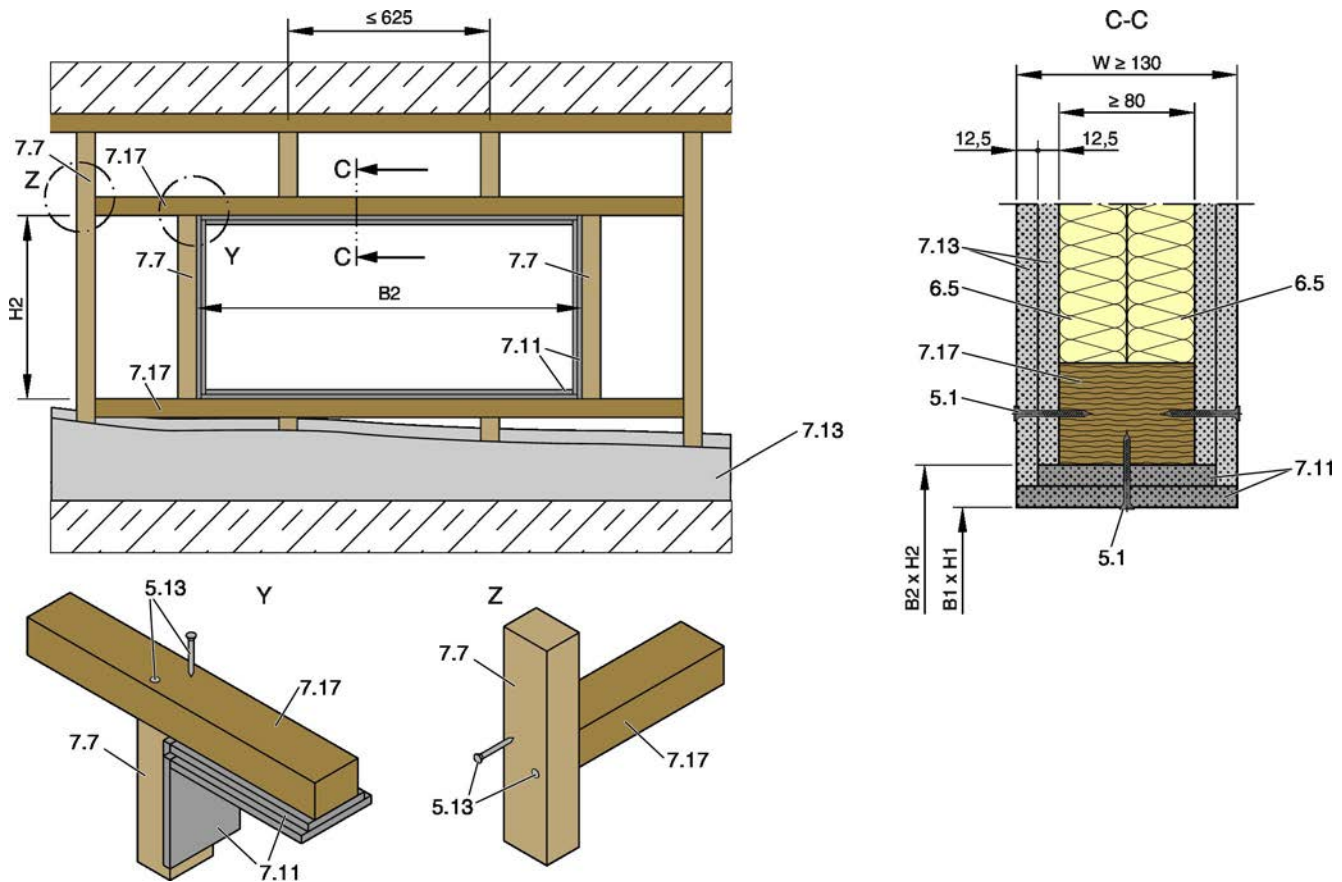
Leichtbauwand mit Holzständer und beidseitiger Beplankung
